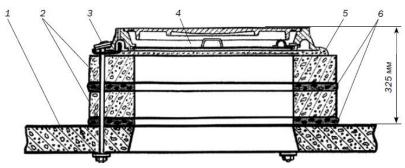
Крепление опорных колец и люка с помощью «СНКЛ-3»:
